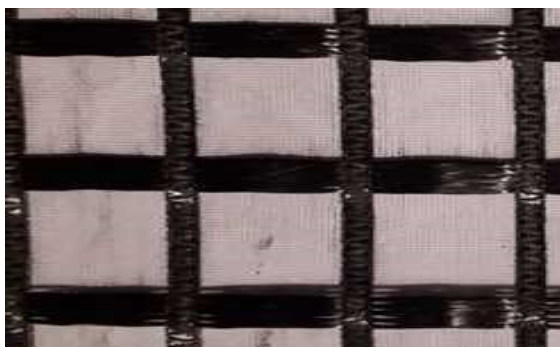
Étapes et dispositifs de fabrication des dallettes renforcées.
